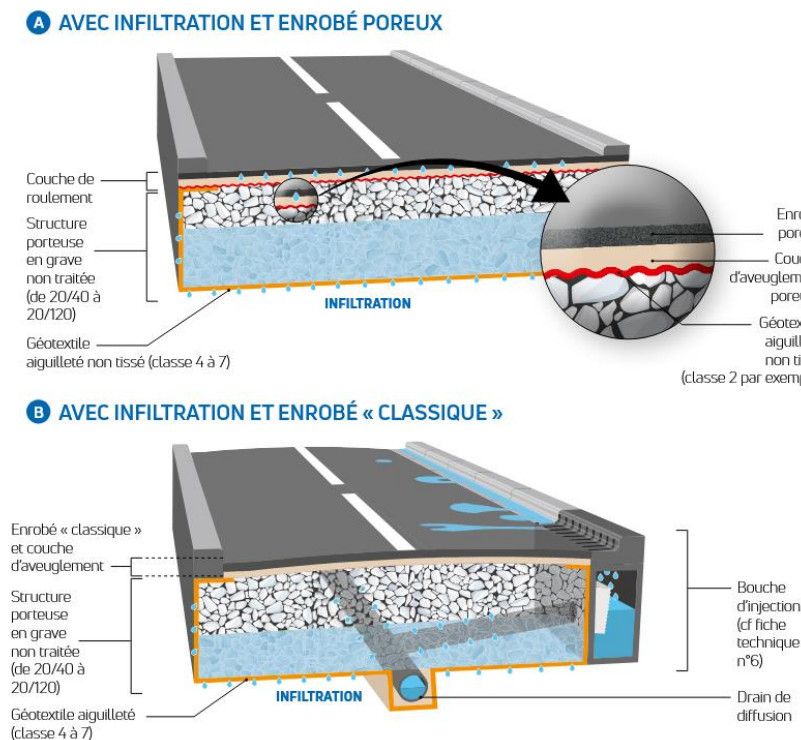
Exemple de chaussées à structure réservoir (issu de : Adopta, 2023)
